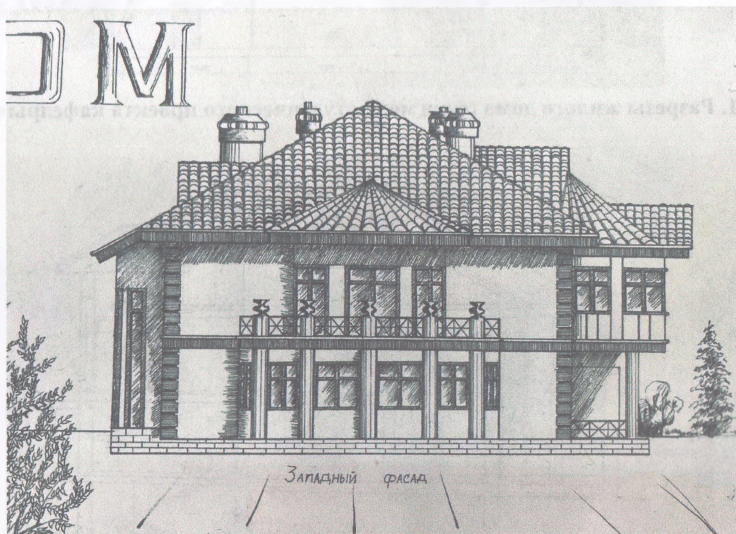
Фасад жилого дома (фрагмент проекта студента гр. ДАС-3-14 Эсеновой Айканыш)
